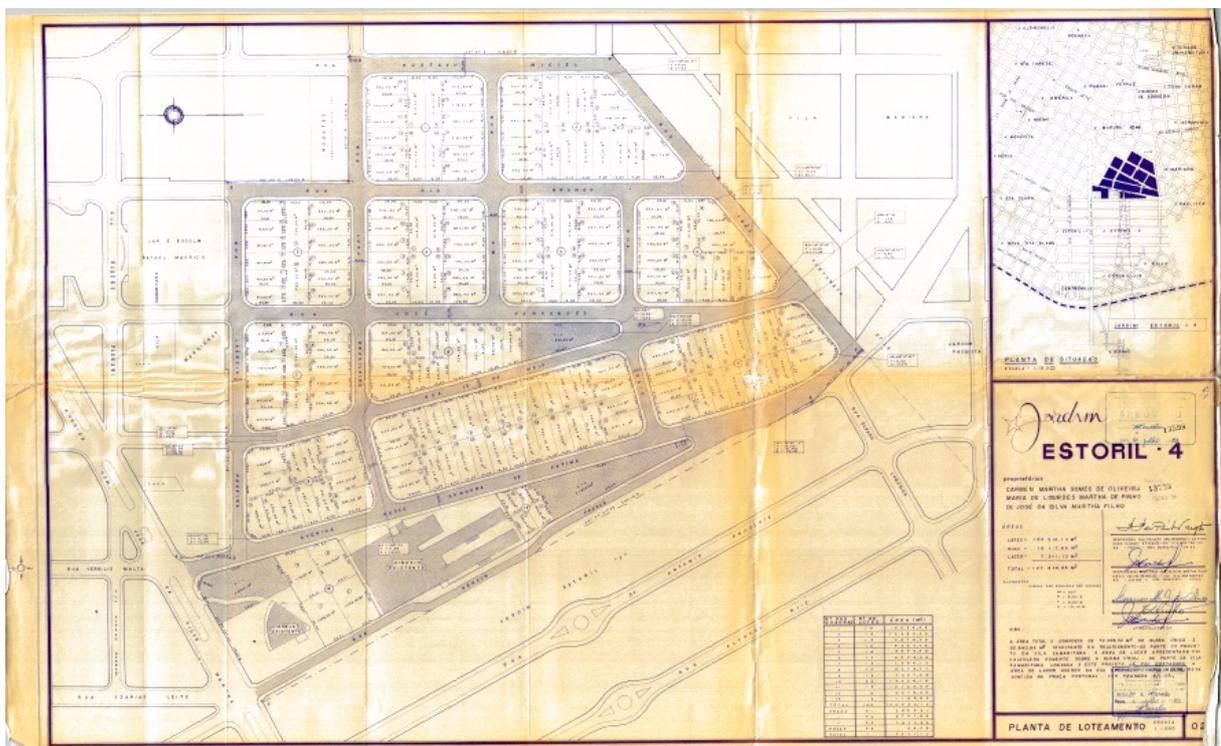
Planta de loteamento Residencial Jardim Estoril 4, aprovada em 1983.
